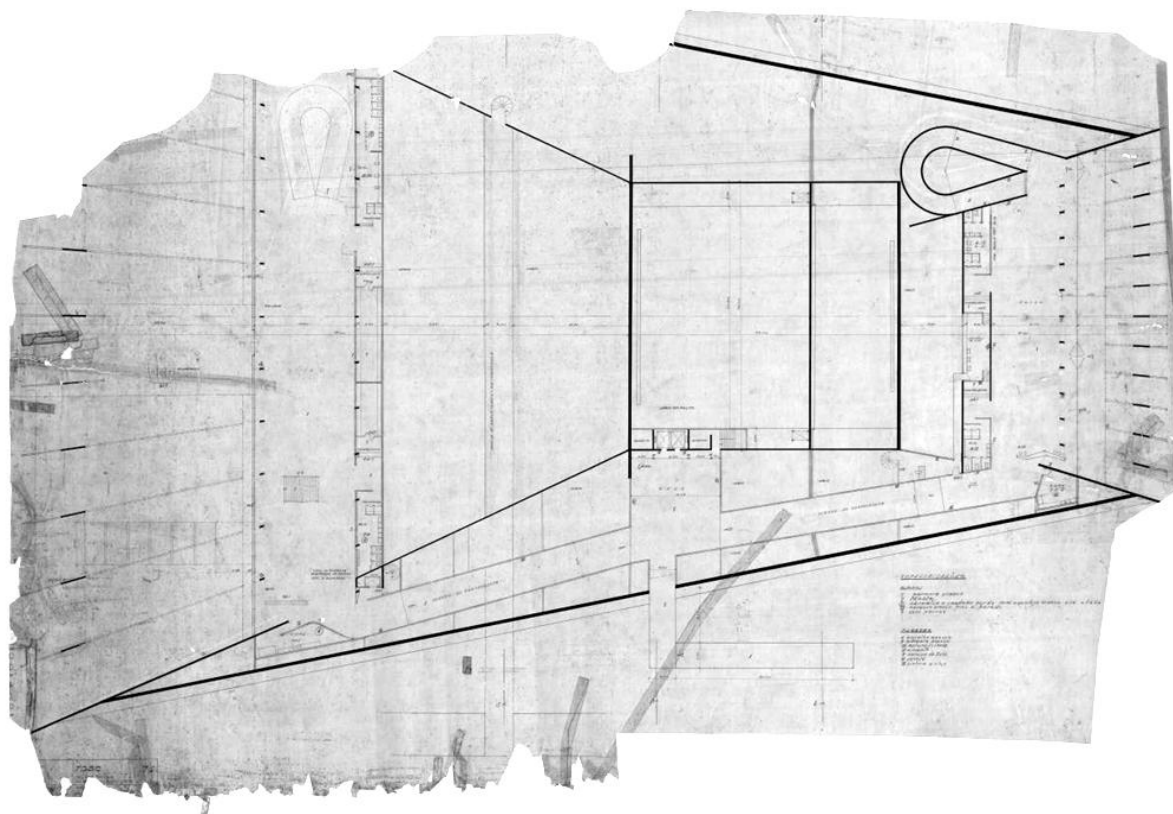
Planta Baixa - Pavimento Térreo (1960). Carimbo: Teatros Oficiais do Setor Cultural Norte, 7.2, NOVACAP. Data: 1960. Fonte: ARPFD.
